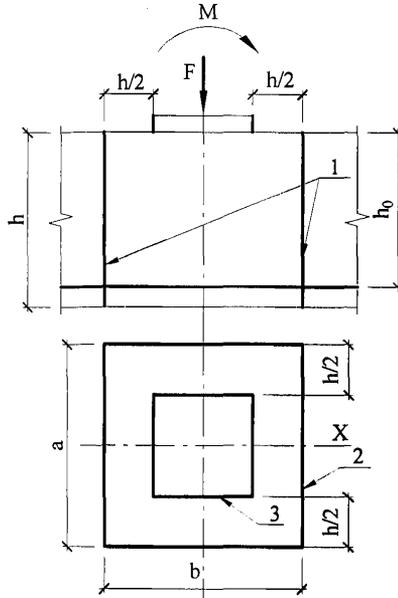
Схема для расчета сталефибробетонных элементов без поперечной арматуры на продавливание;
